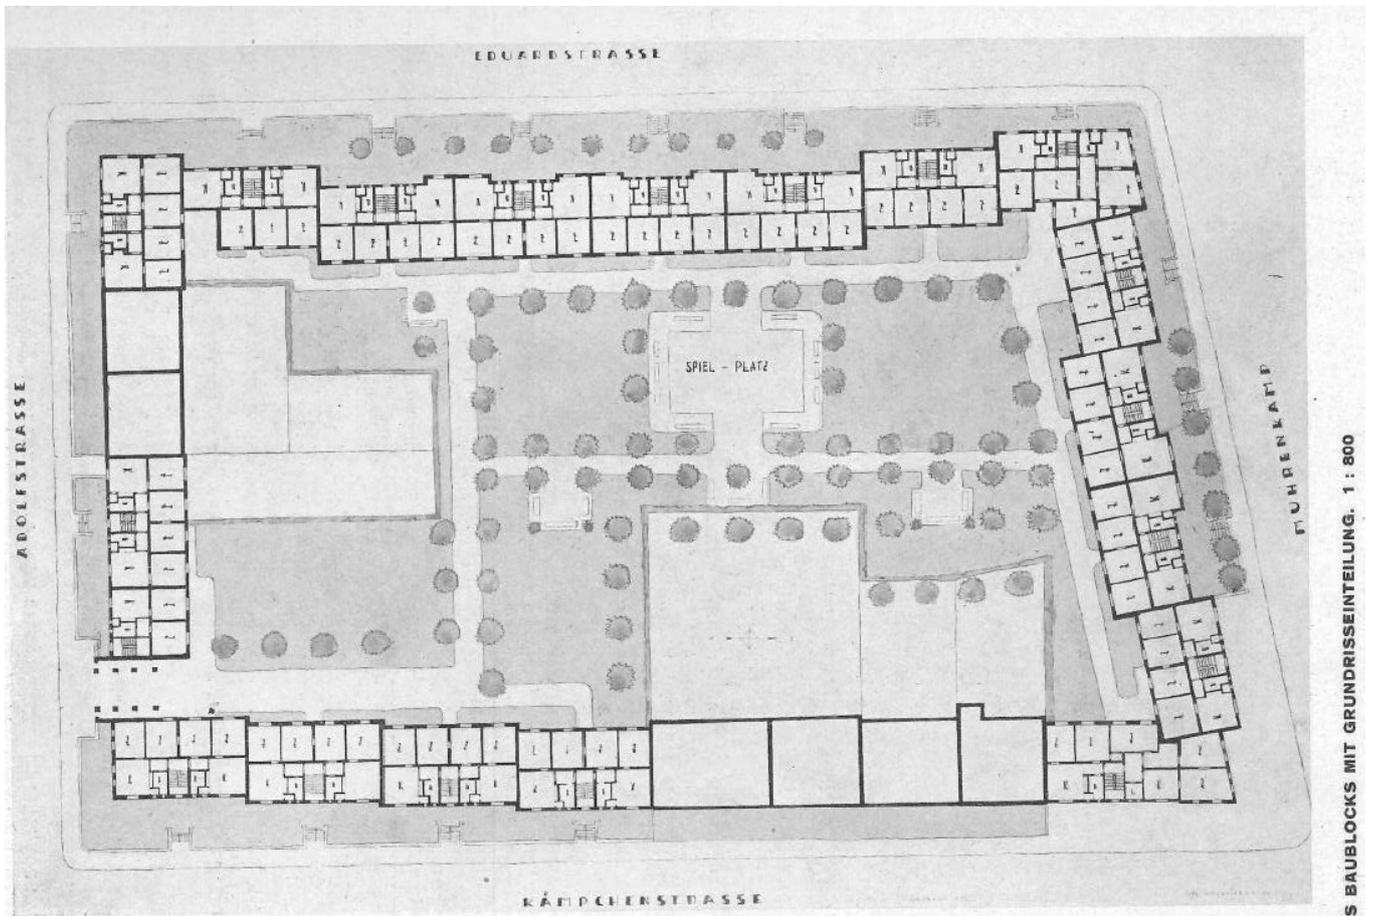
Bauzeitlicher Grundriss, Repro aus: Moderner Wohnbau 1929, S. 98.
